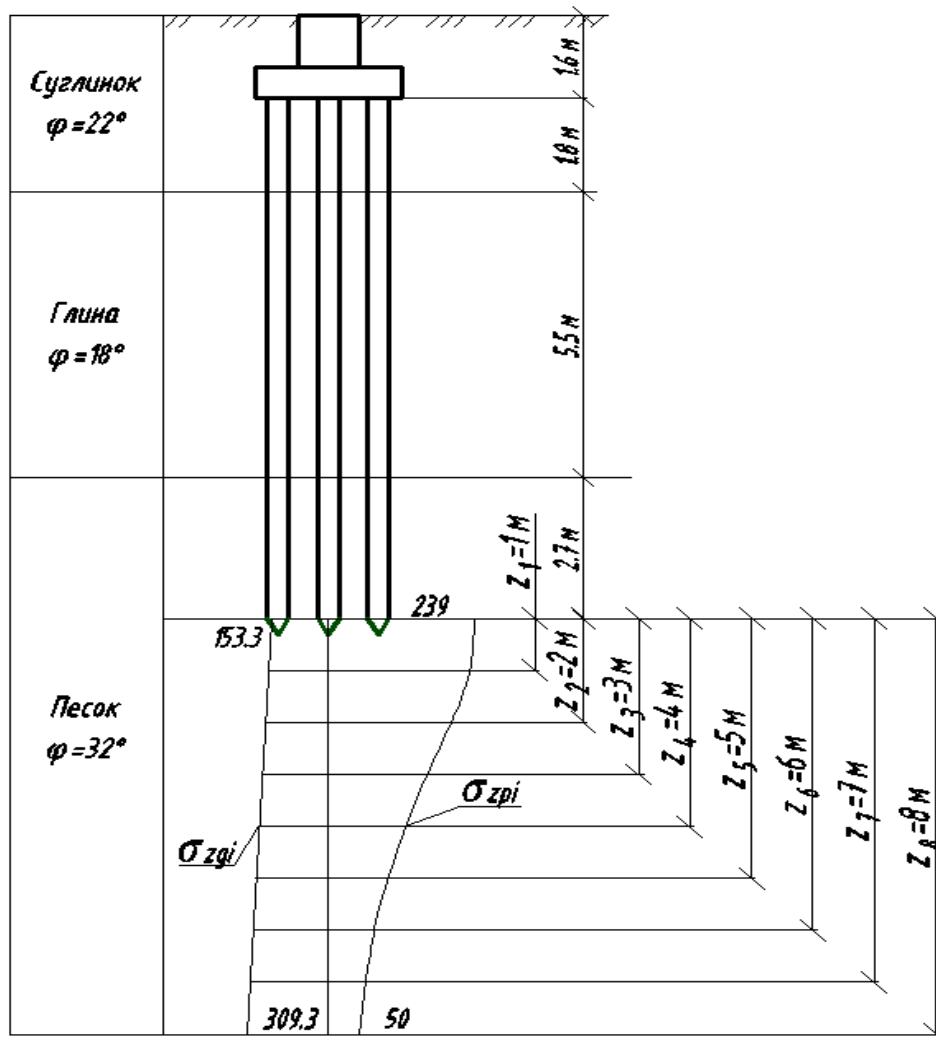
Расчетная схема к расчету осадок свайного фундамента
